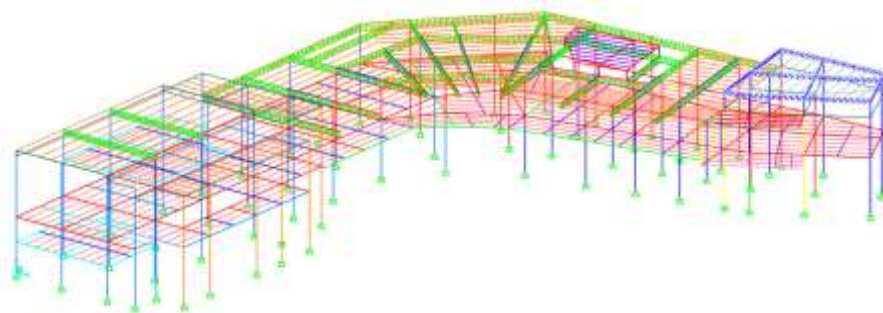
Entrepiso estructural en el software SAP2000 del sistema de la losa Metaldeck.
